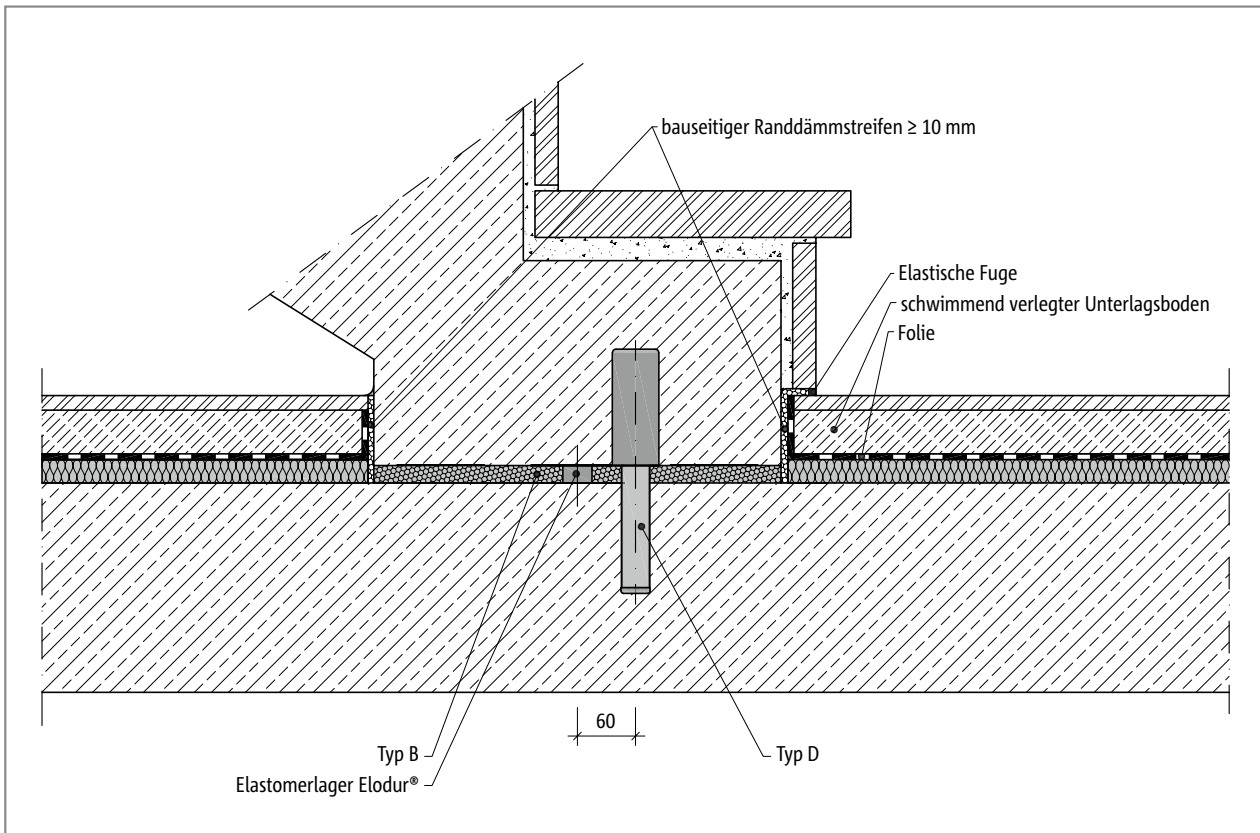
Schöck Tronsole® Typ B + Typ D: Einbauschnitt
